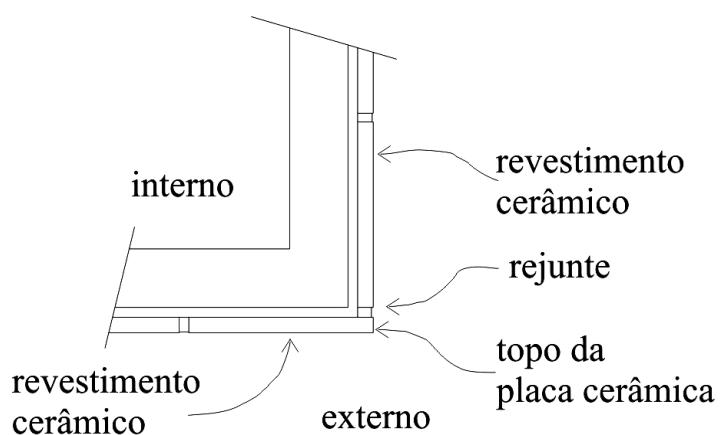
Encontro entre placas cerâmicas de fachadas adjacentes
